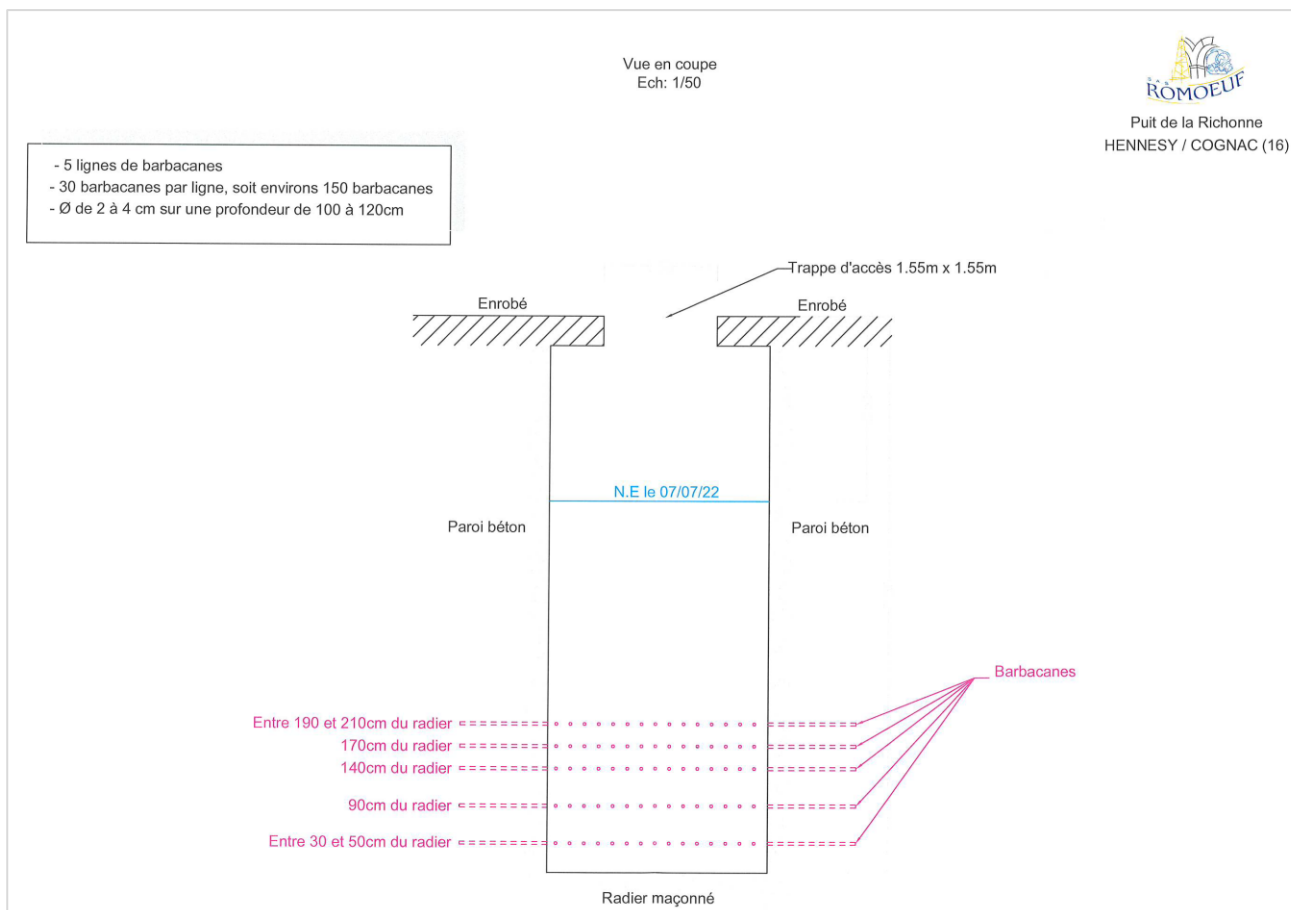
Plan du puits (selon les observations du plongeur de ROMOEUF – Juillet 2022)
